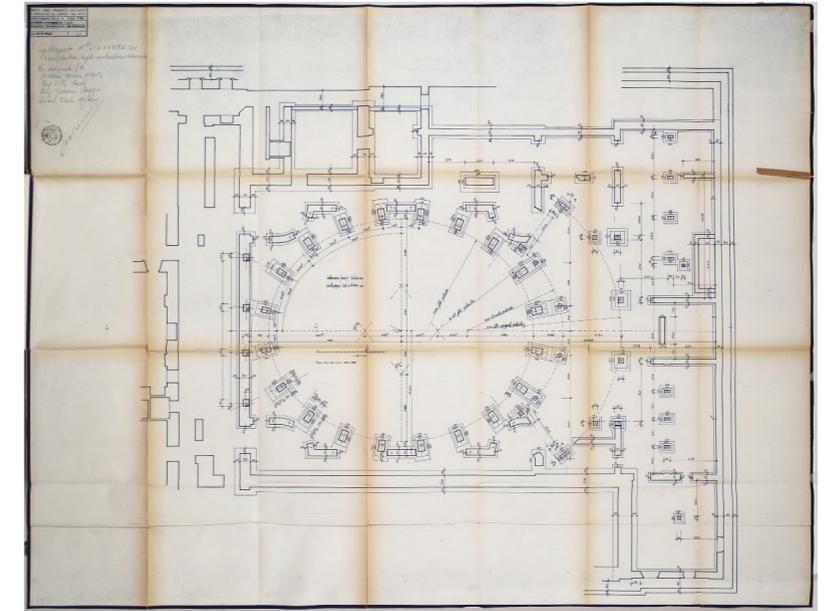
Progetto strutturale ad opera dell'ing. Franco Jacazio, dis. 6011_1 - *Pianta fondazioni generale*.
